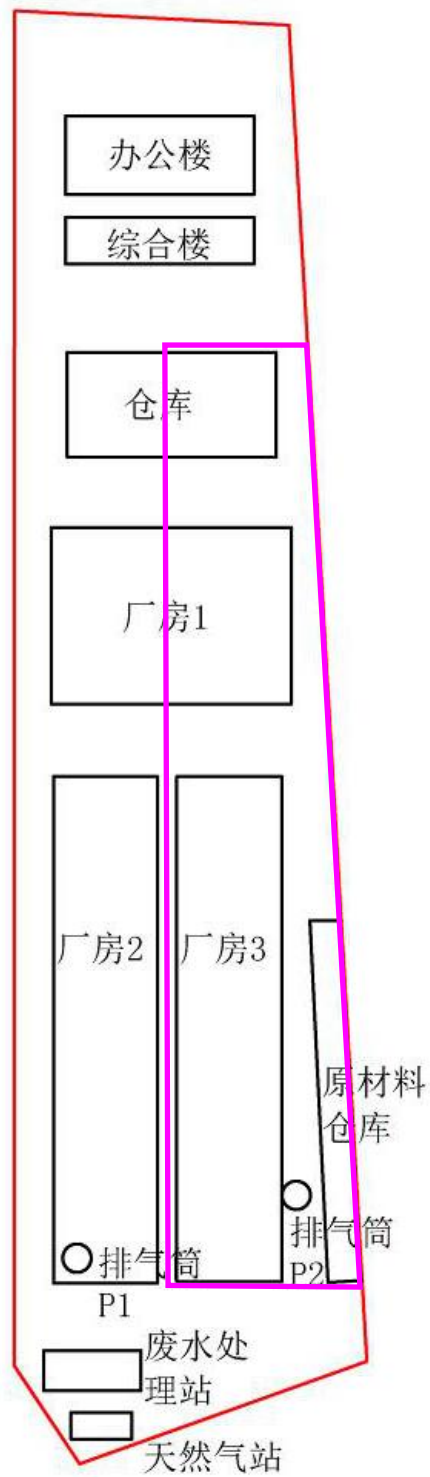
项目总平面图（紫色范围为本次扩建项目范围）
